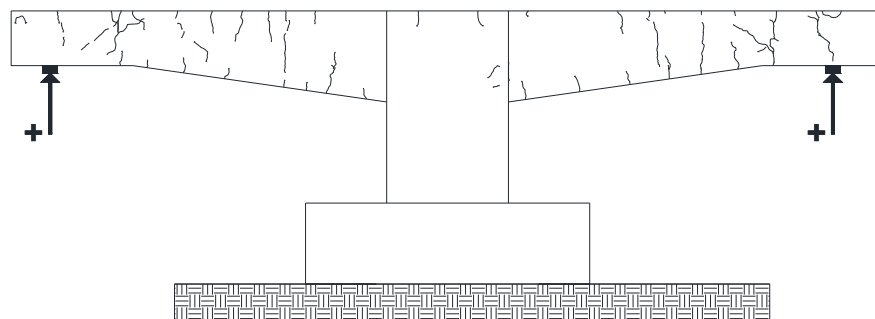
Dirección y ángulo de grietas principales
